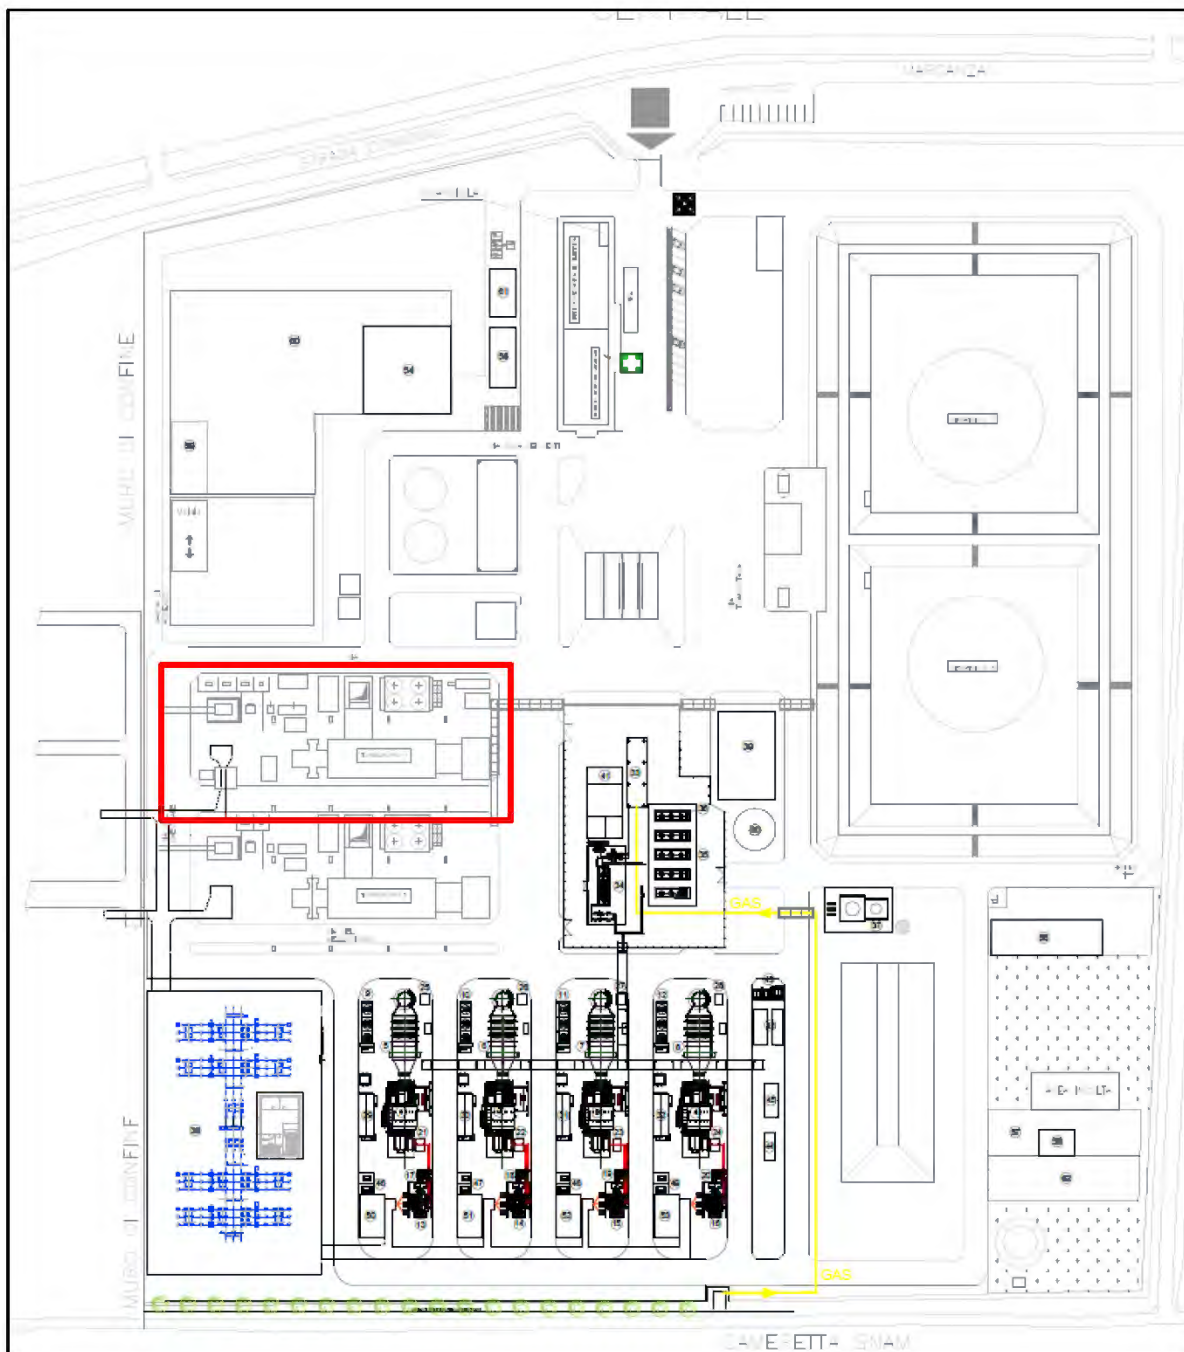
Planimetria Generale Situazione Futura (in rosso TG oggetto di Dismissione)
